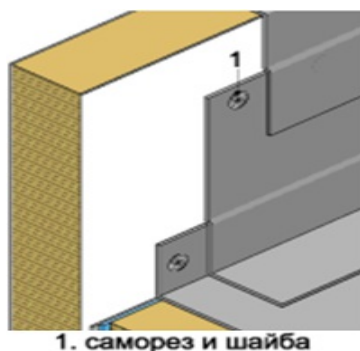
Промежуточное крепление с помощью крепежных элементов, металлической рейки и полосы из ПВХ мембраны
